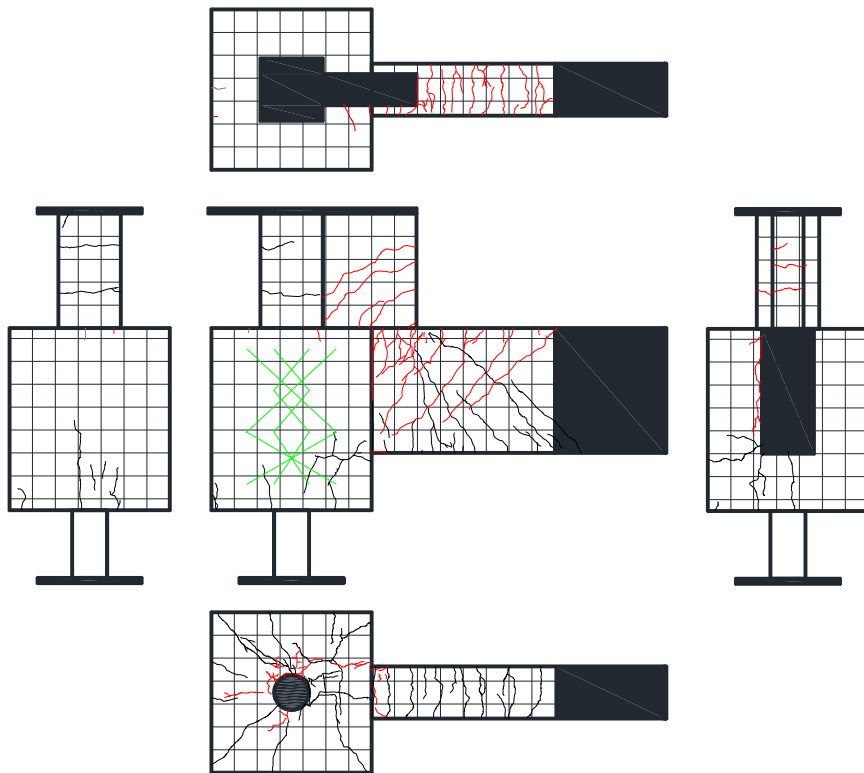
試験体 DR-2 ひび割れ状況 (6Cycle)
